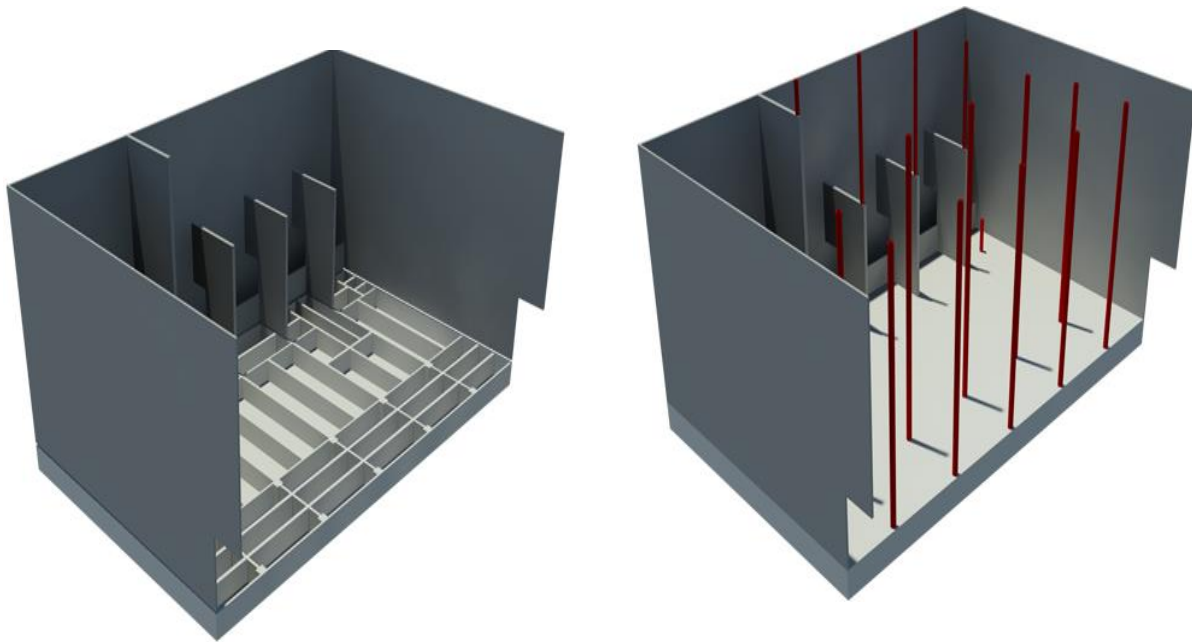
Estructura de acero y concreto y muros de carga de concreto reforzado. Adaptado de
